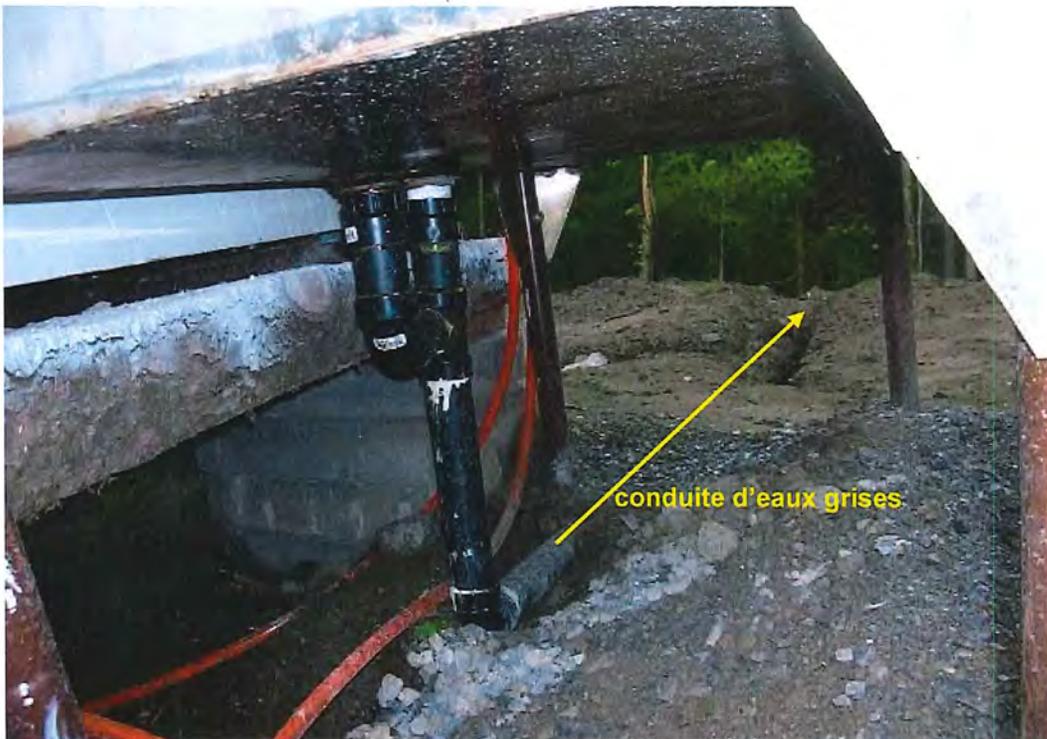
resto El Rancho - lavabo extérieur - conduite d'eaux grises en direction du bois
